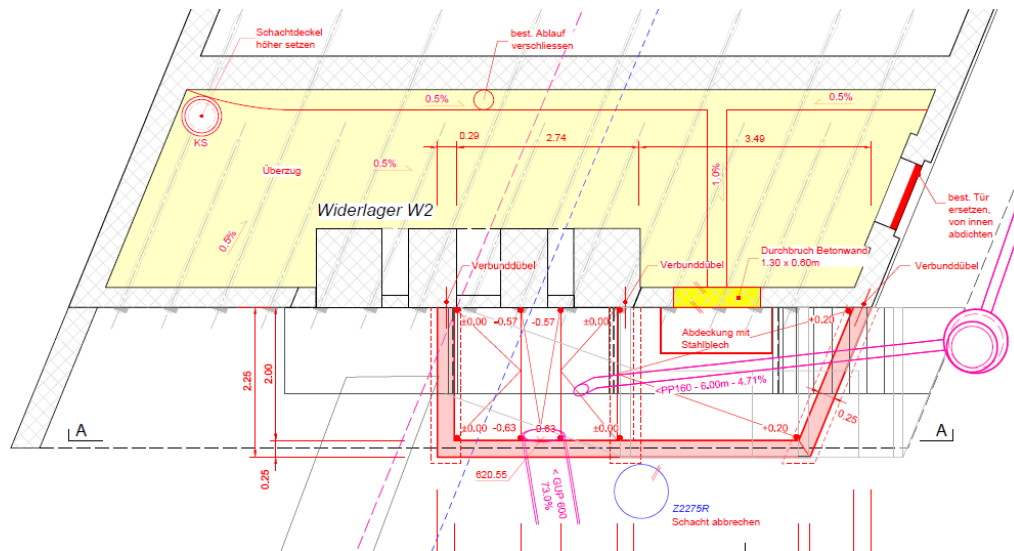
Grundriss Einlaufbauwerk beim Widerlager W2
